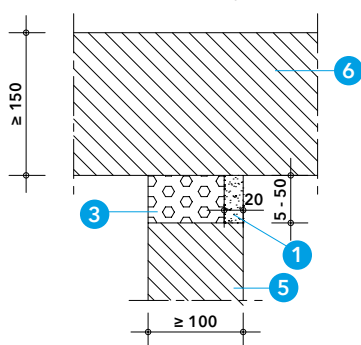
Detail E - pohled shora - svislá spára ve stěnové konstrukci EI 90
